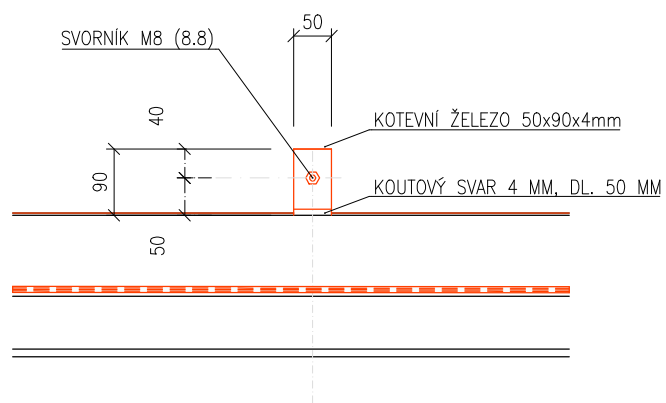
OKAP POVLAKOVÝCH PLOCHÝCH STŘECH, M 1:10
